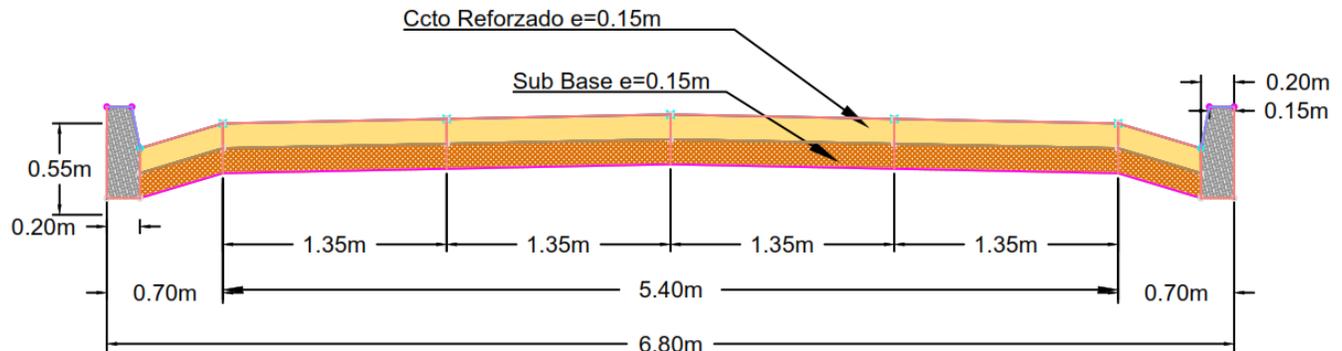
Sección transversal zona de cruce (sobre ancho) placa huella ancho 6.8 m
